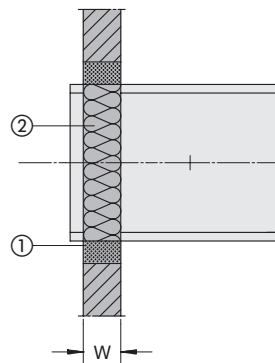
Einbau mit nur teilweiser Ausmörtelung
